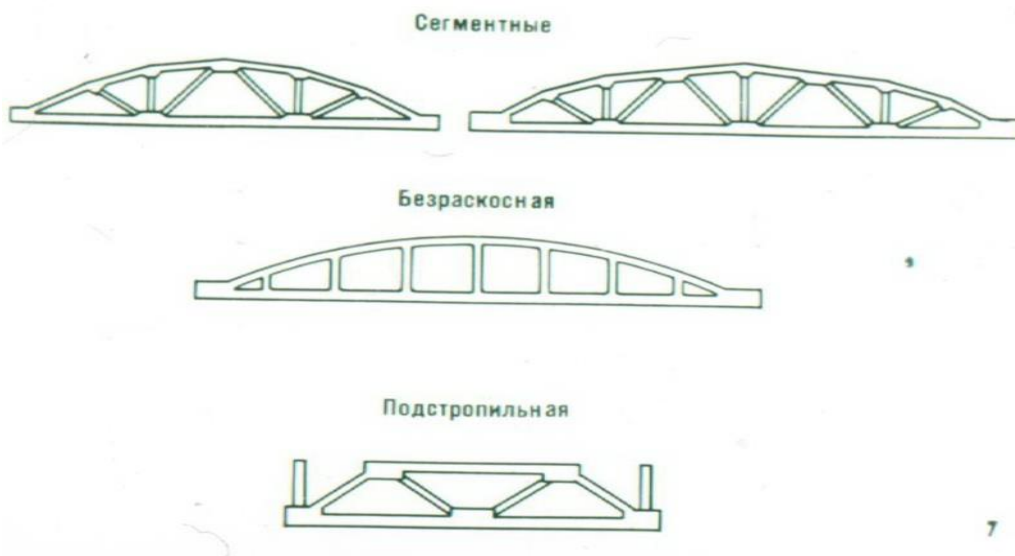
Ферми покриття попередньо напружені залізобетонні
